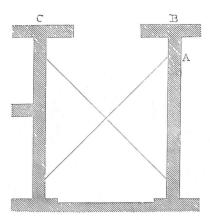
Contrarresto de una bóveda de arista empleando como estribo parte de los muros transversales
